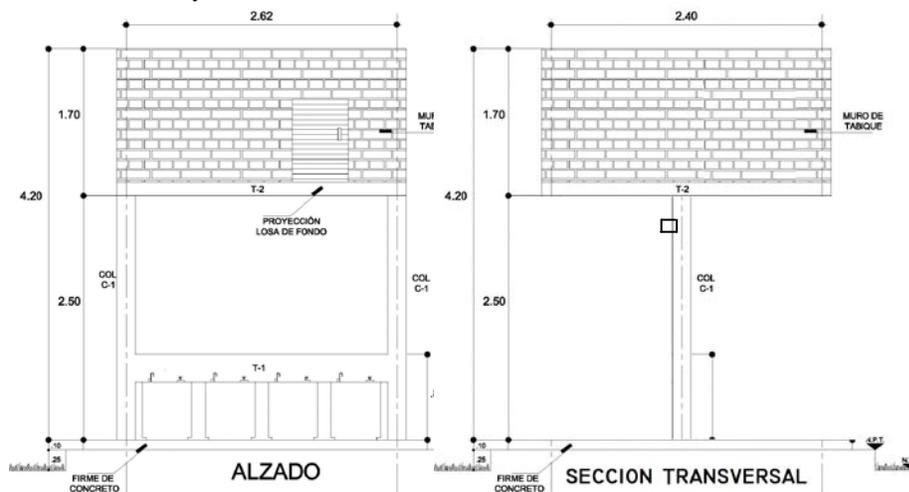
Alzado y sección transversal de estructura y cubo de tinacos.
